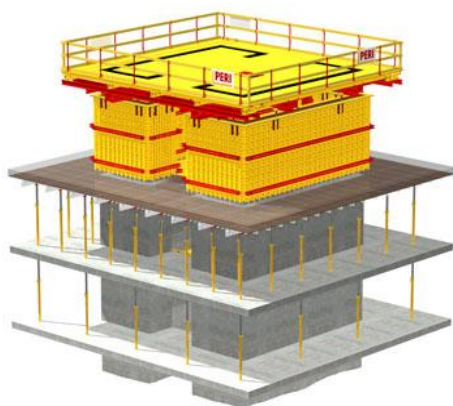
Paredes e lajes elevadas de uma única vez (PERI s.d.).
